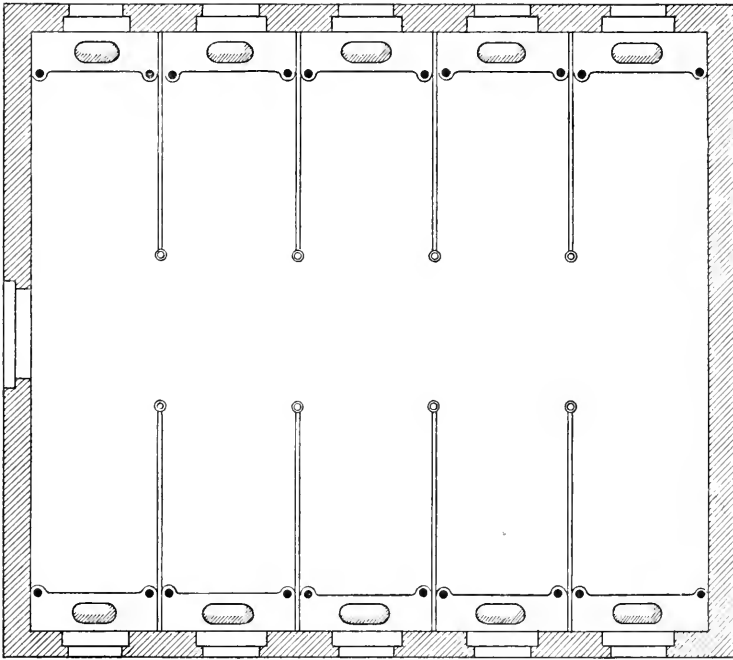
Grundriss eines doppelreihigen Stalles für 10 Pferde. (Kastenstandbreite 2,00, Standlänge 3,00 und Stallgassenbreite 2,25 m.) (Kelle & Hildebrandt-Dresden.)
